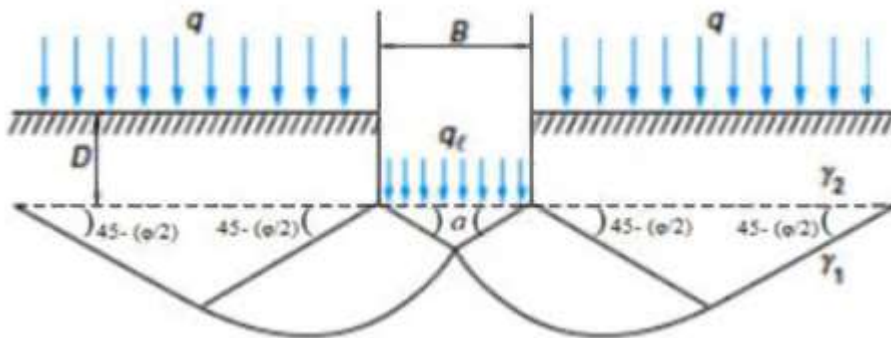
Schéma de rupture d'une fondation superficielle.
